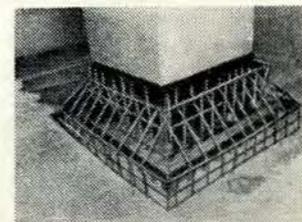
Анкерное крепление опоры эстакады к перекрытию тоннеля метро
